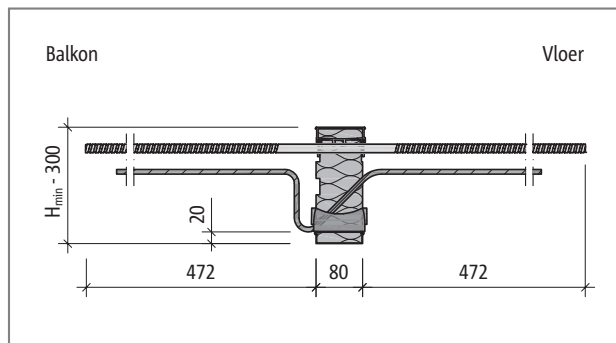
Schöck Isokorb® CT type K-T-M5-V2-CV30: bovenaanzicht
